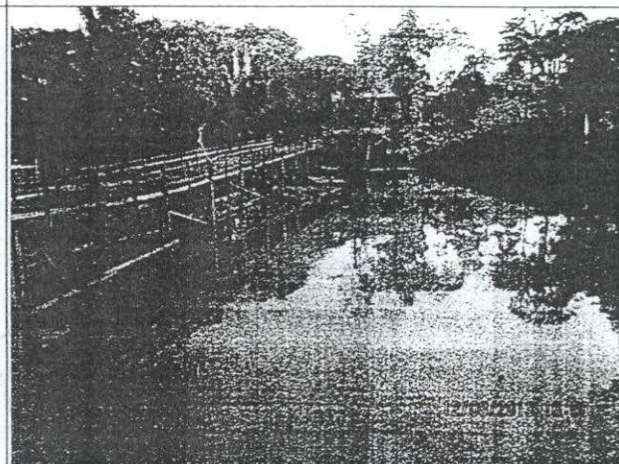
Observação da porção final do pier que dá acesso a um restaurante.
